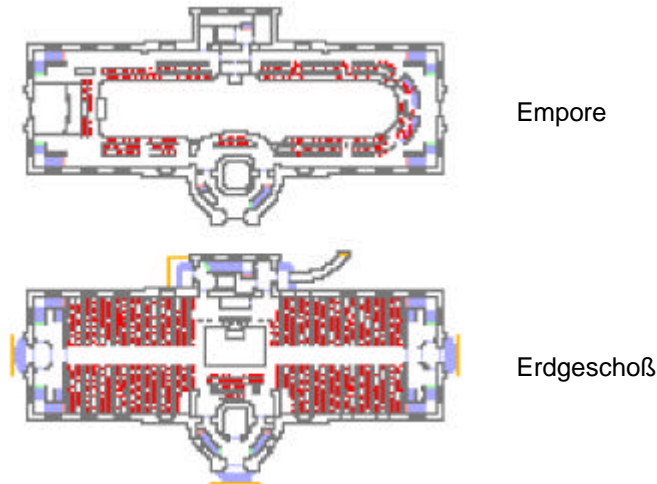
Modellierter Grundriss mit Treppen und Personen.
